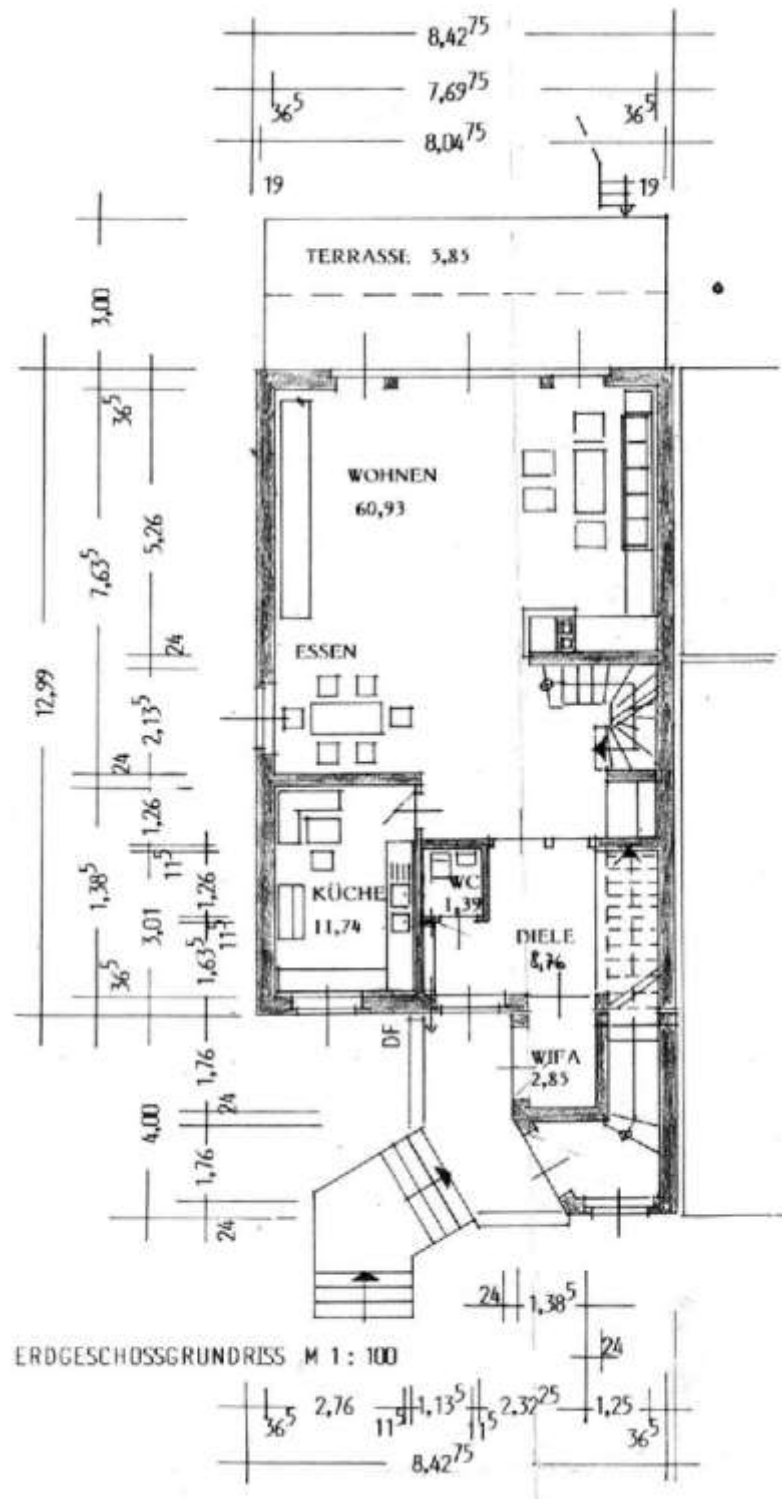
Grundriss EG Quelle: Unterlagen der Gläubigerin
